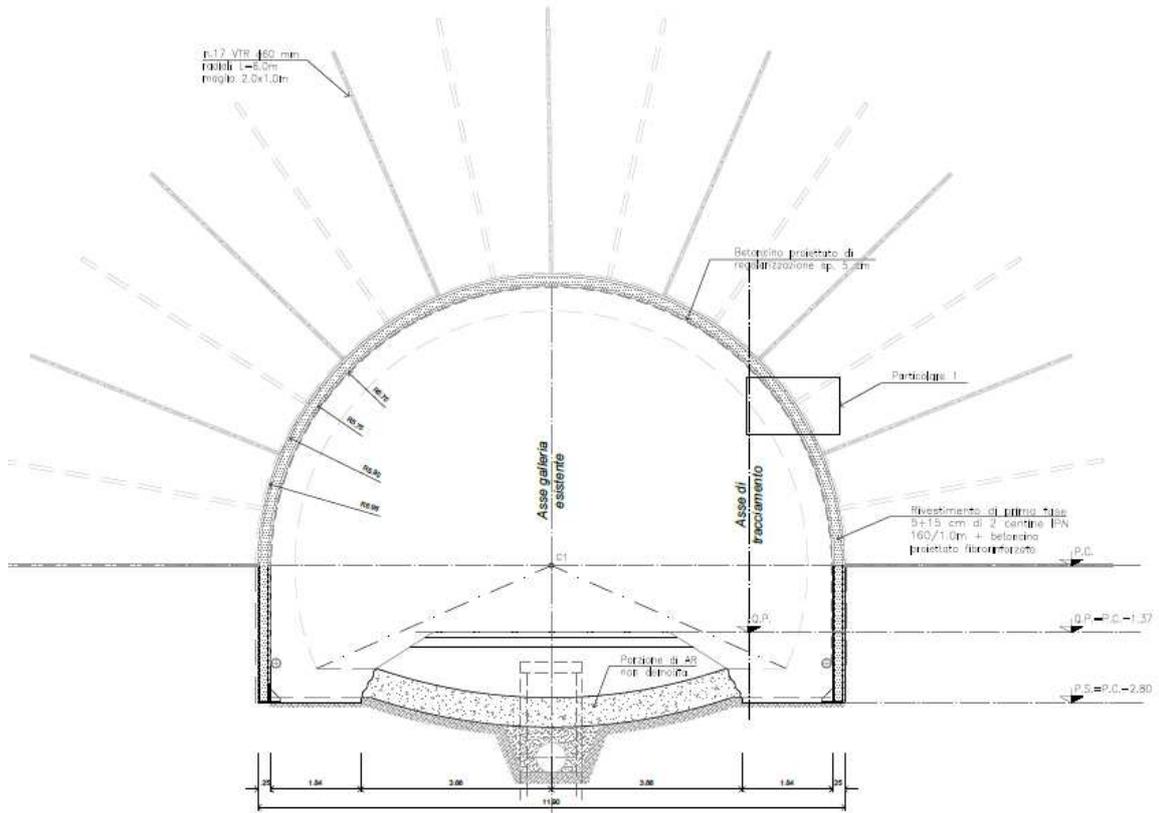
Galleria Guinza – Intervento Tipo A – Sezione corrente – Scavo – Sez. 2
